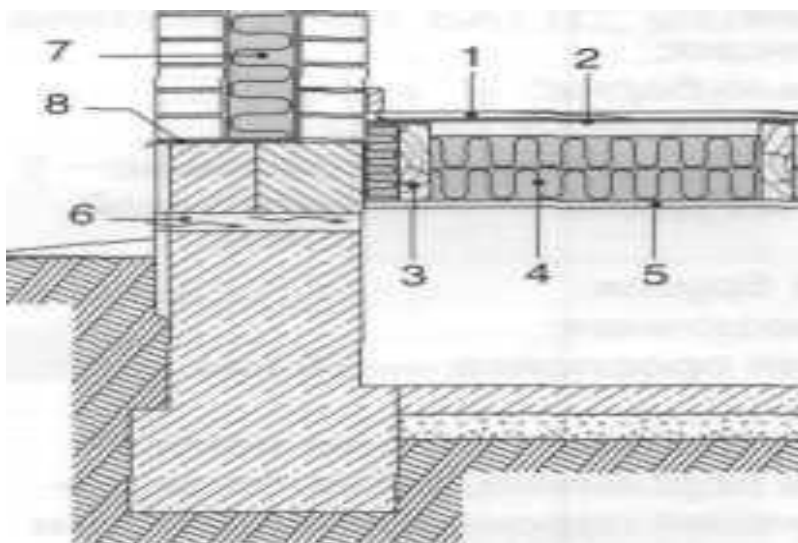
Утепление перекрытия по деревянным балкам над вентилируемым подпольем или подвалом:
